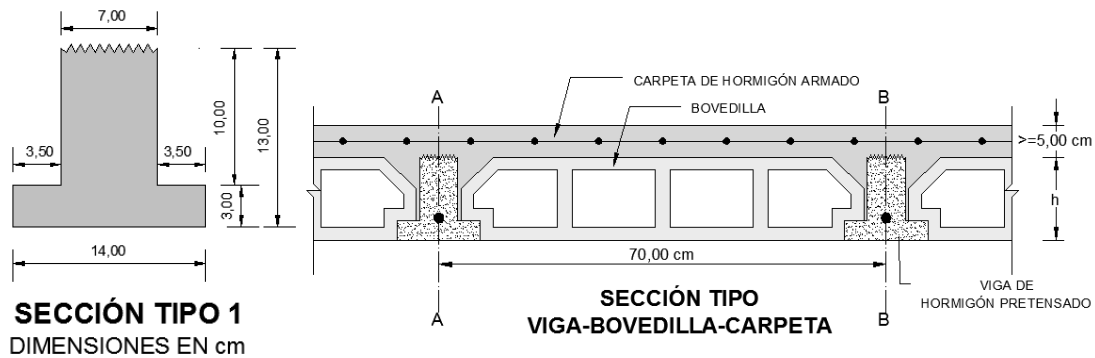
Sección Transversal inicial Viga de L=3,00 m.
